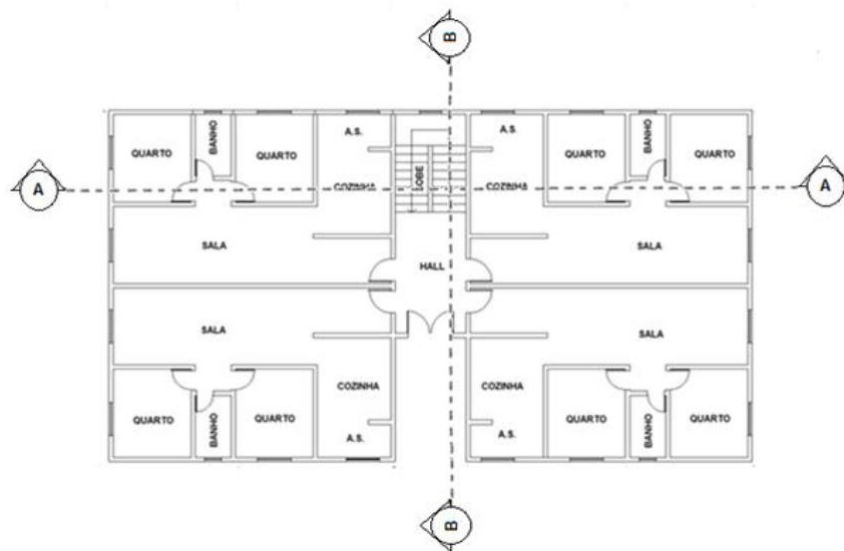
Planta de arquitetura com eixos de corte (SALLES apud MUNIZ, 2018)
